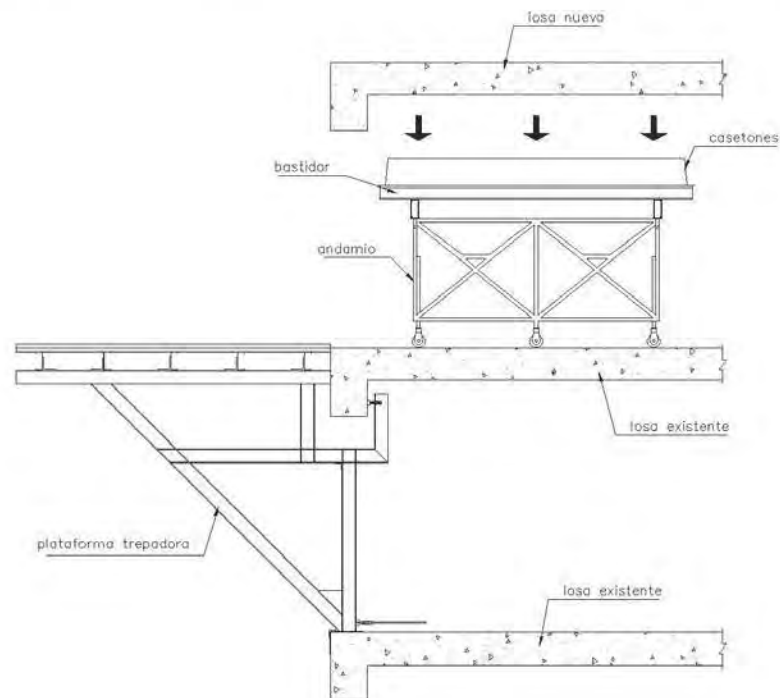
y 3.5.19 Mesas de colado y tapas de cimbra de columnas
